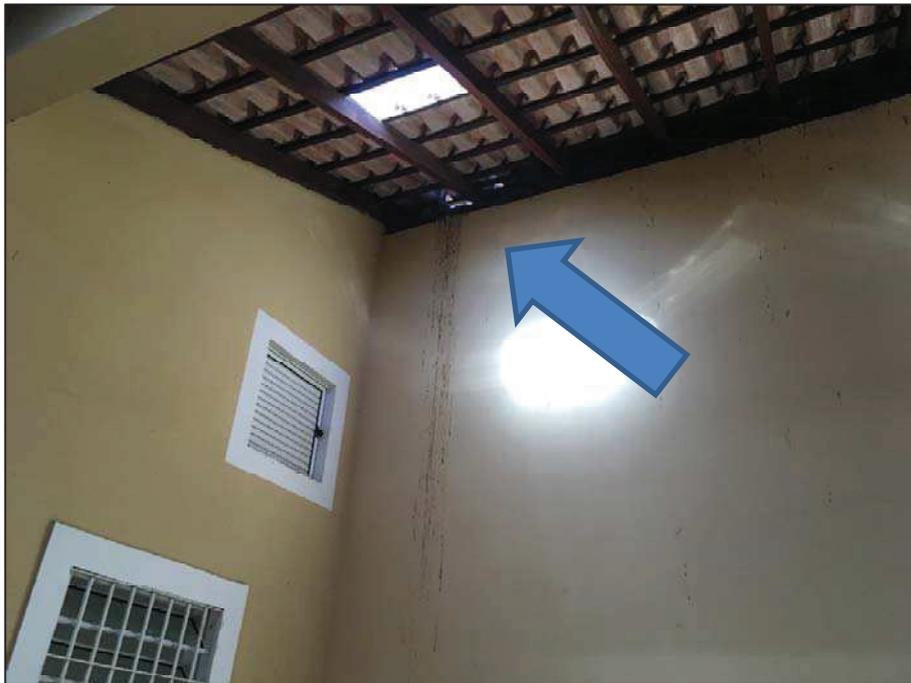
Detalhe da infiltração na garagem do imóvel avaliando.
